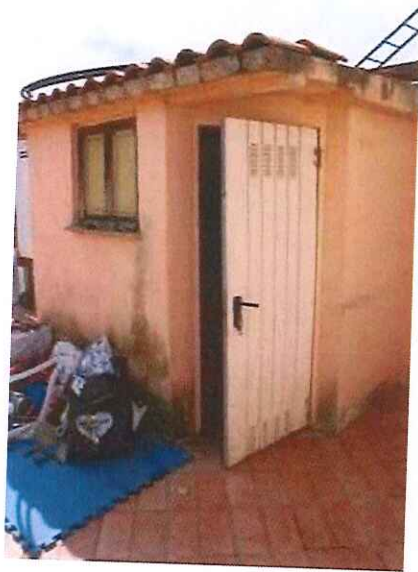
Foto 25 – Lotto 1 – Locale Tecnico
